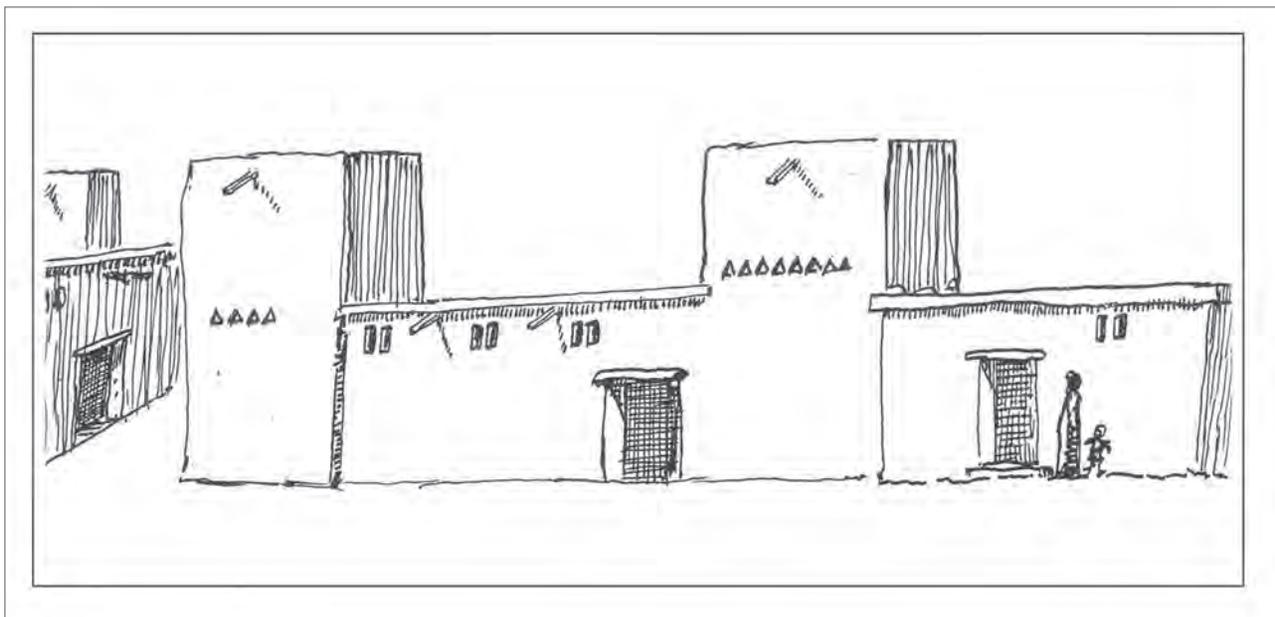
Propuesta de Llobregat del alzado de la fachada del almacén.
